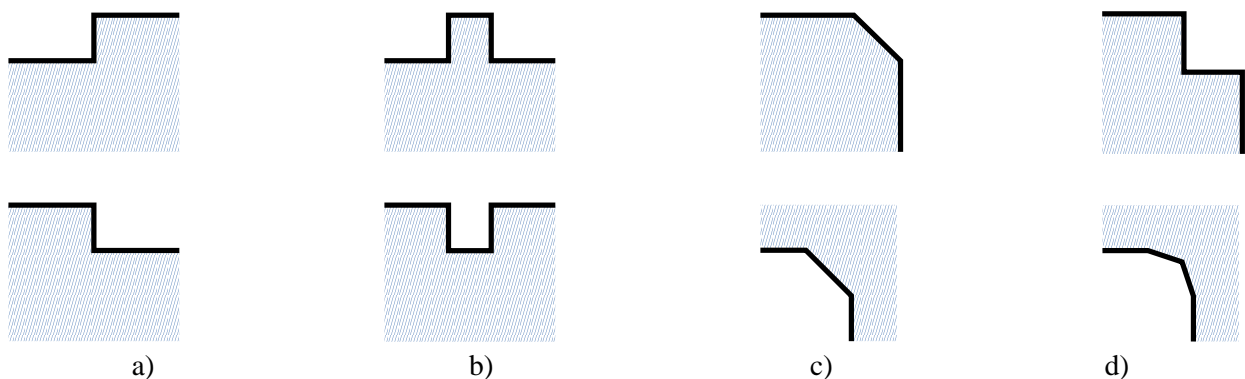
Grundrisselemente a) Seitenversprung, b) Vorsprung (oben) und Einsprung (unten), c) Eckversprung, d) doppelter Eckversprung
